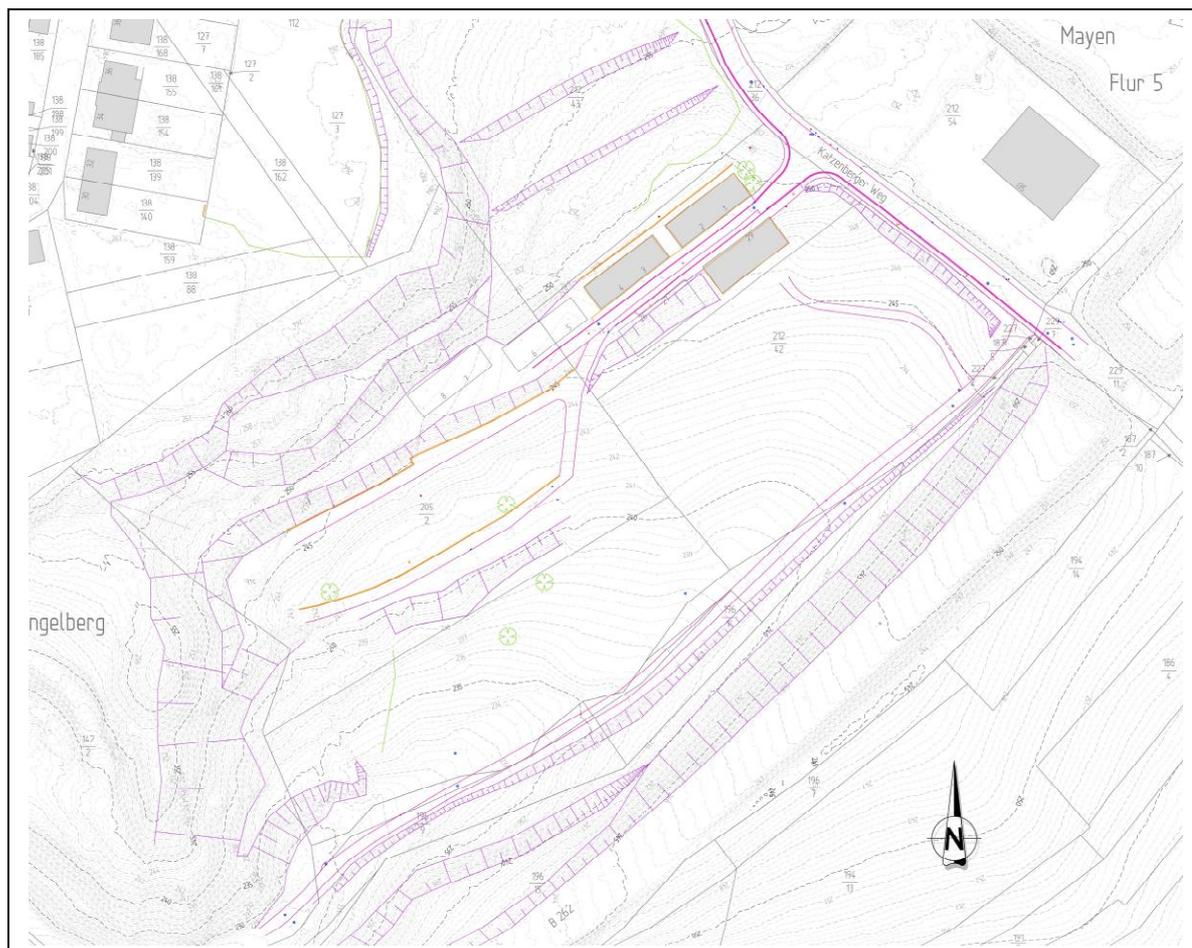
Gelände- und Bebauungsstruktur des Plangebietes (unmaßstäblich)
